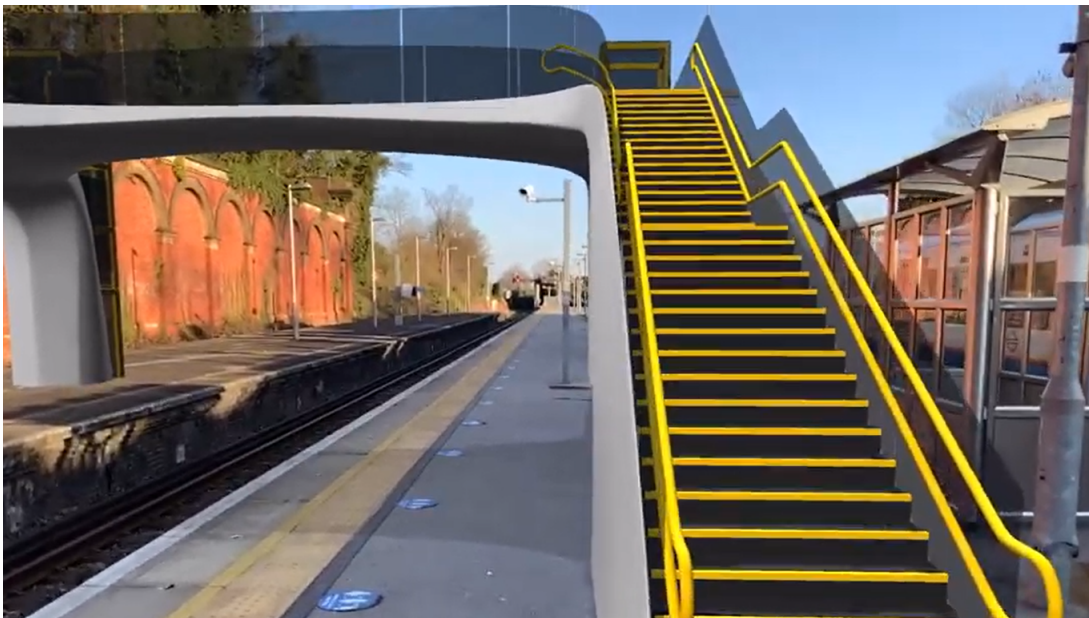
Proyección de modelo de puente sobre lugar donde se construirá, generada por ARki - Fuente: <https://youtu.be/mnoIe1J4Izc>
